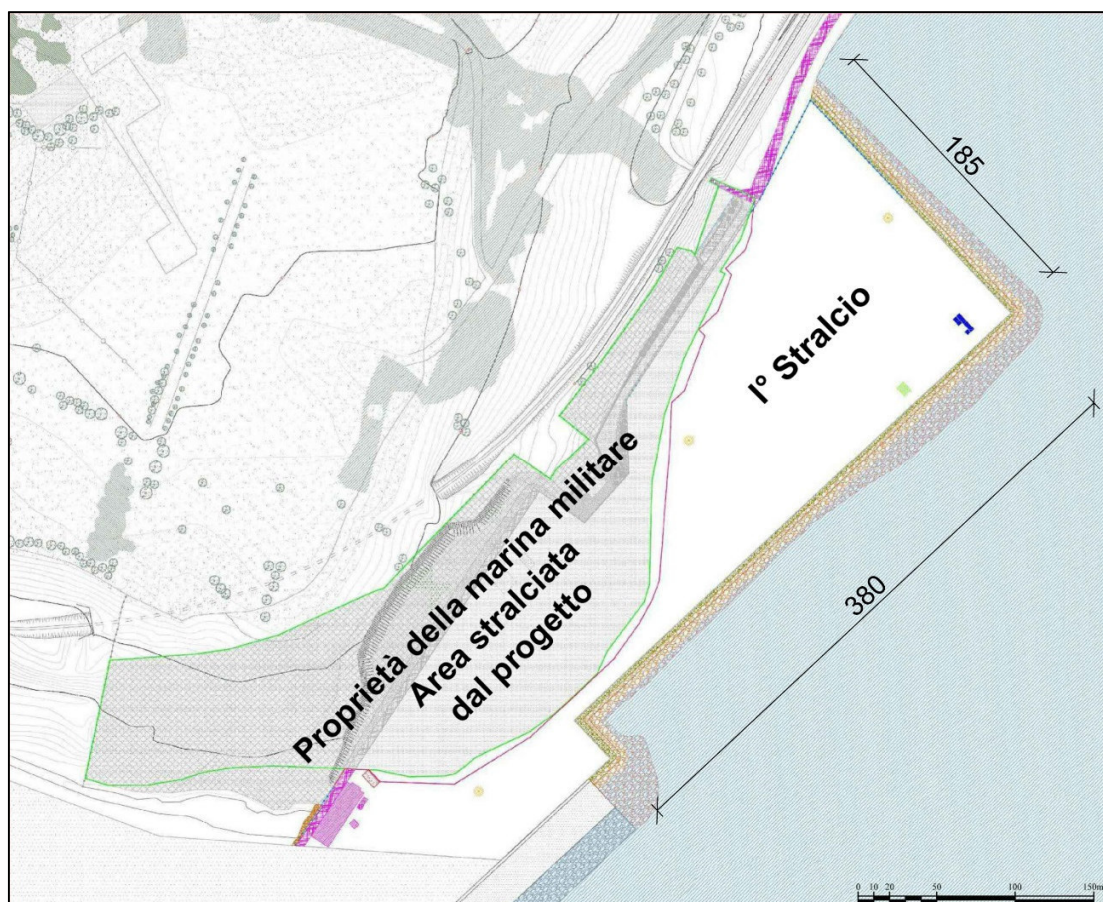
Planimetria piazzali progetto esecutivo I stralcio
